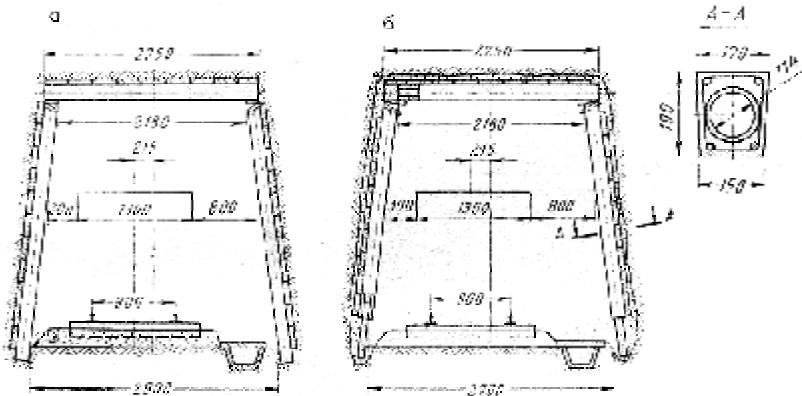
Кріплення із залізобетонних пустотілих елементів:
